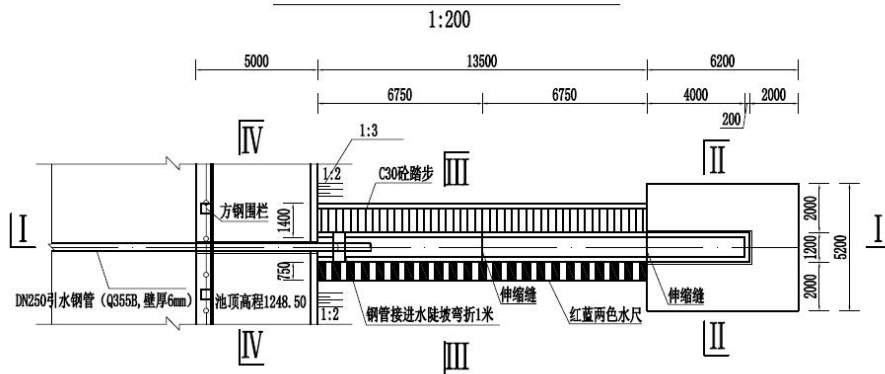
1#调蓄水池进水陡坡、消力池平面图（单位：mm）
